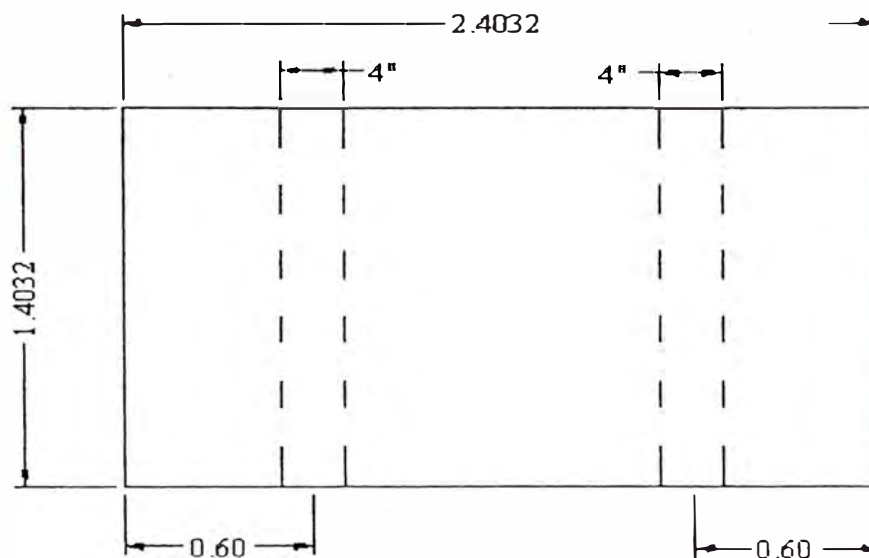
PLATAFLORMA FINAL Y VIGA TRANSVERSAL
